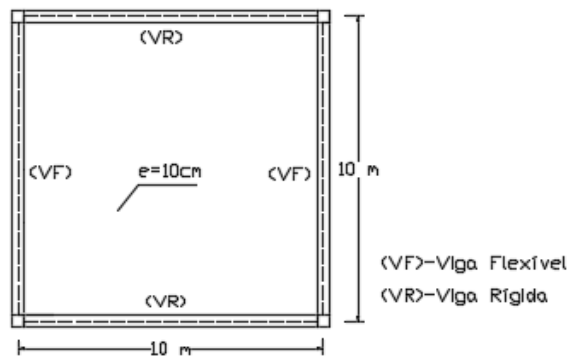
Planta da laje com indicação das vigas rígidas e flexíveis.
